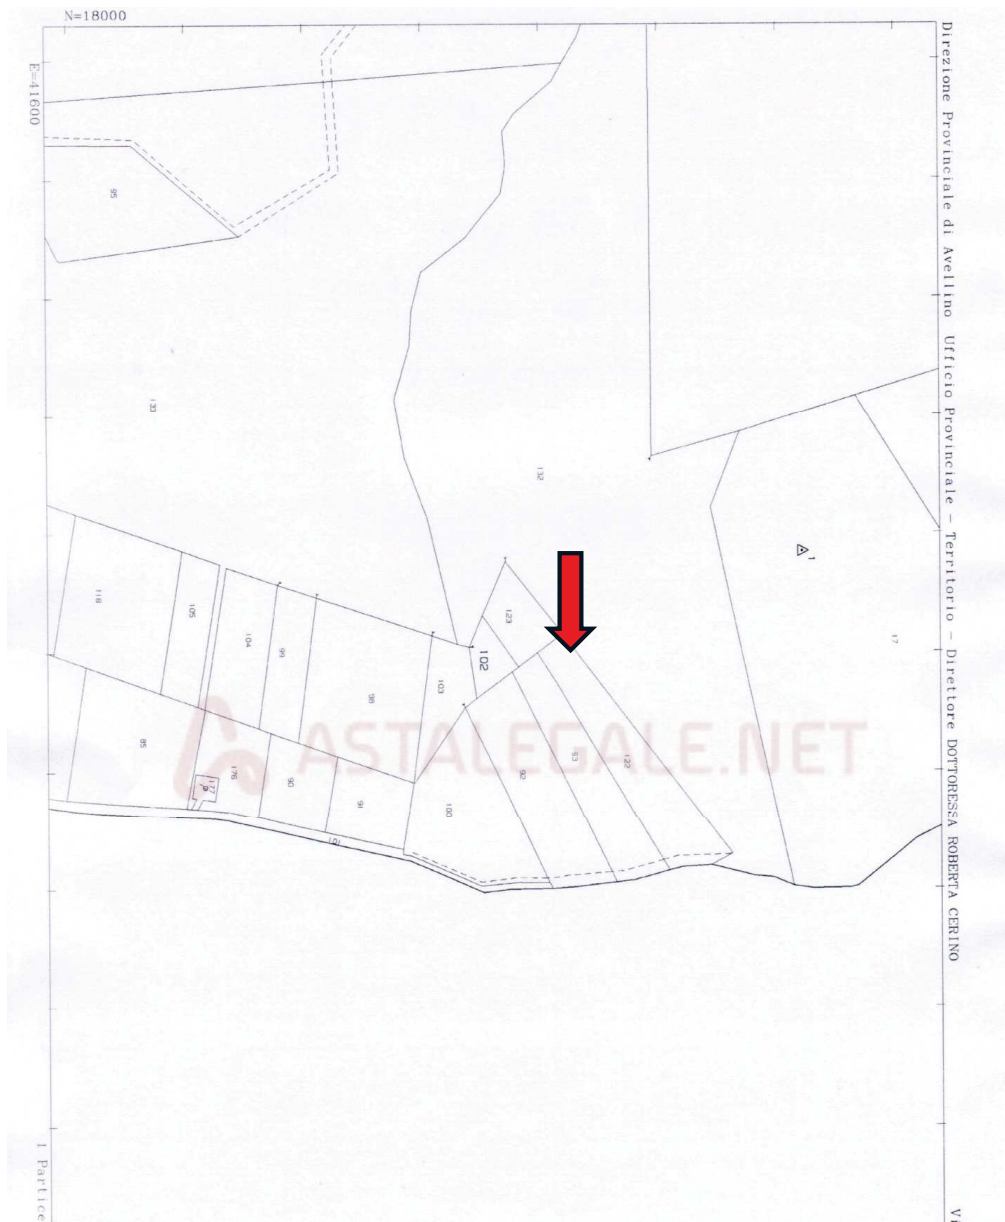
Foto N. ...< Stralcio planimetrico Foglio di mappa 52 – Part.lla 102/122 – LACEDONIA (AV) - Alleg. N. 03>
